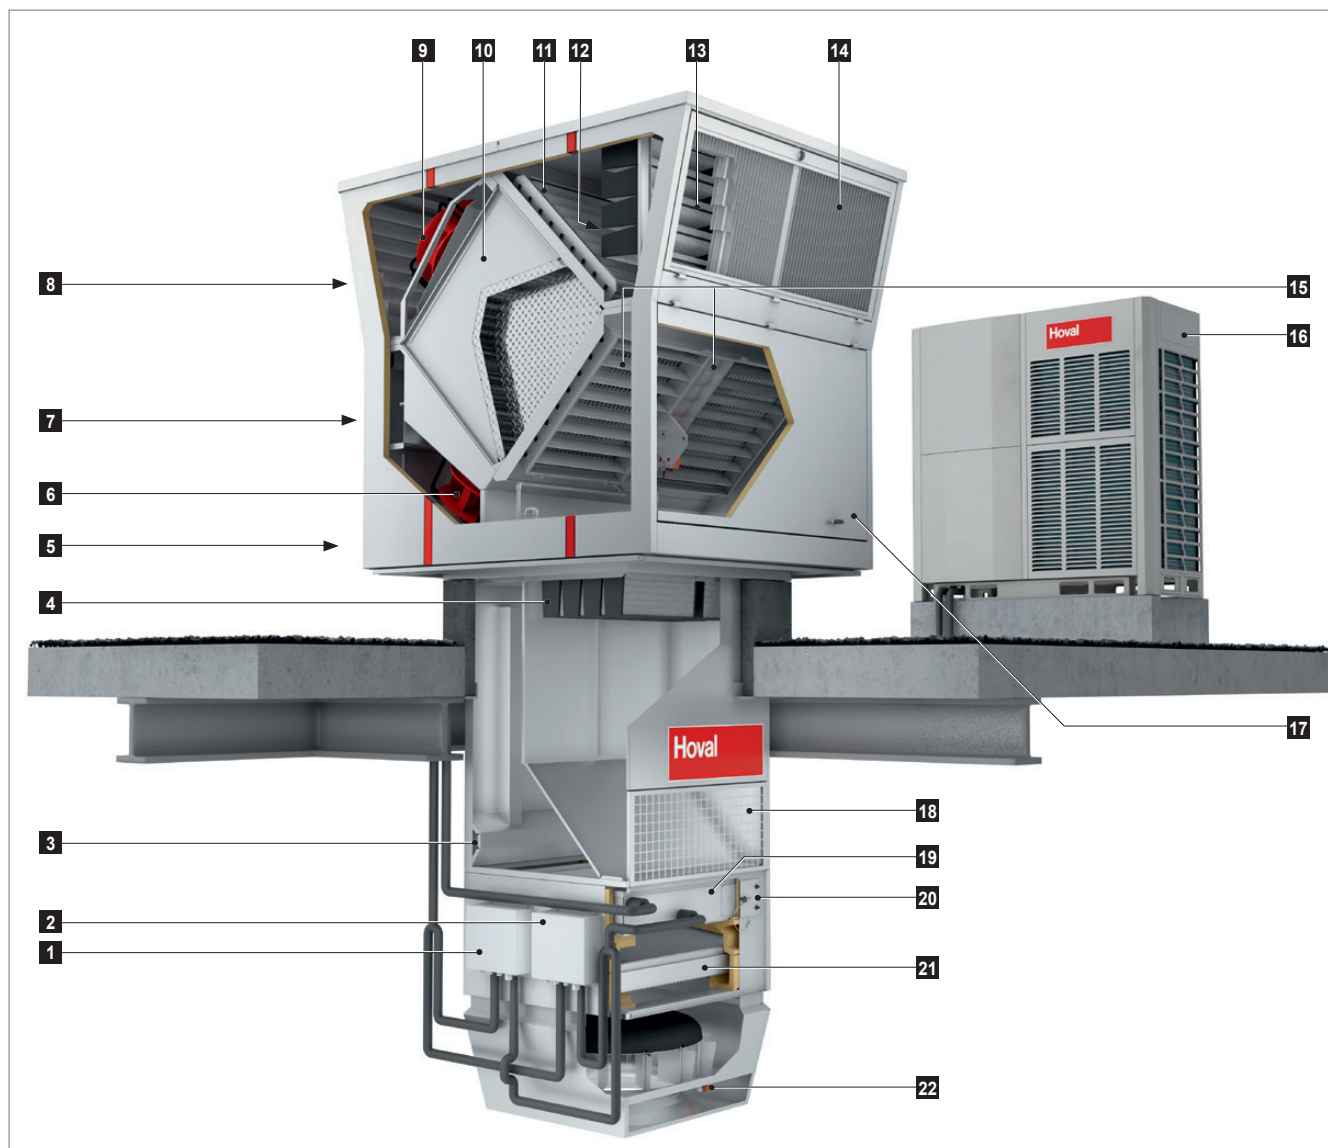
Konstrukcija RoofVent® RP-6 jedinice
